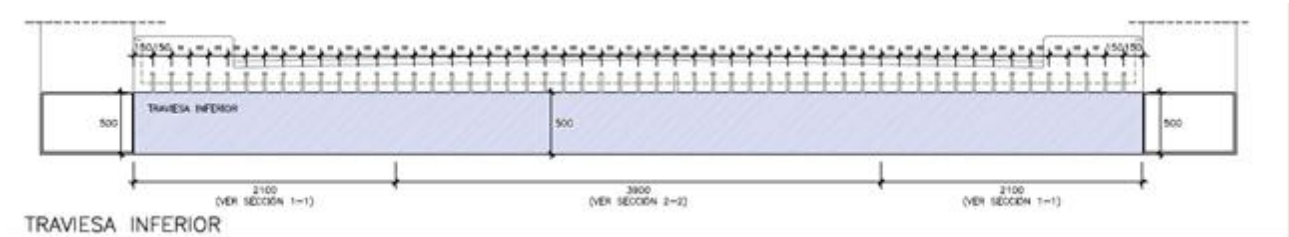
Alzado de la celosía metálica entre cordones inferiores
